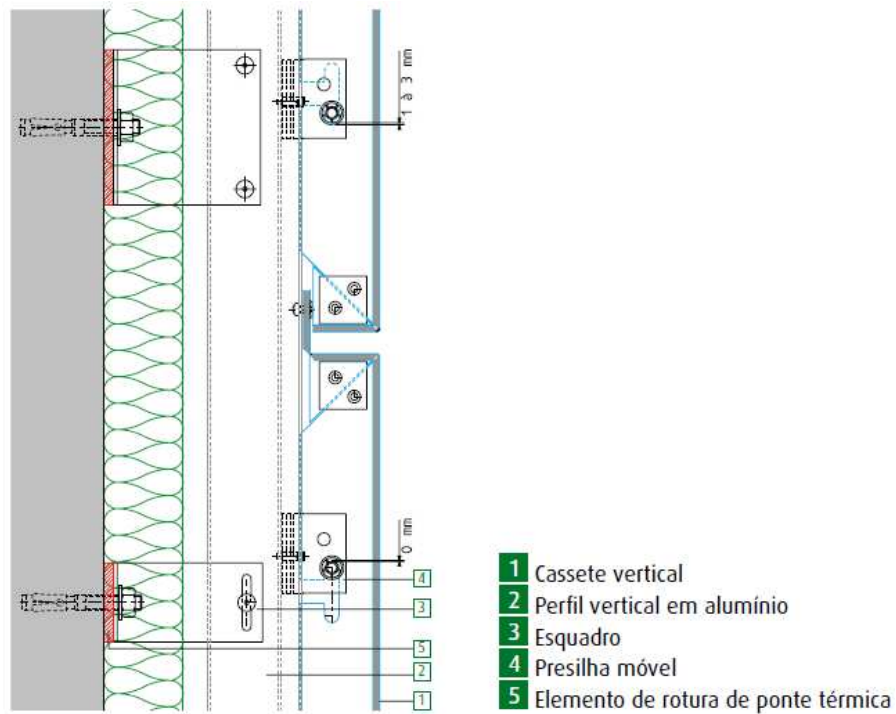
Pormenor construtivo do sistema de cassetes verticais [6]
